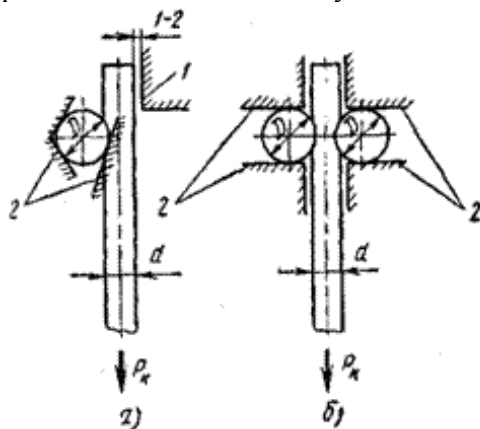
Схема испытания на срез крестообразных соединений арматуры;
